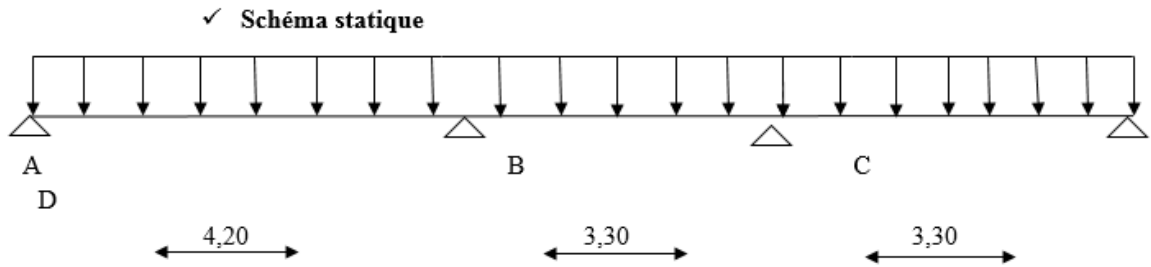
schéma statique de l'ensemble des poutrelles
